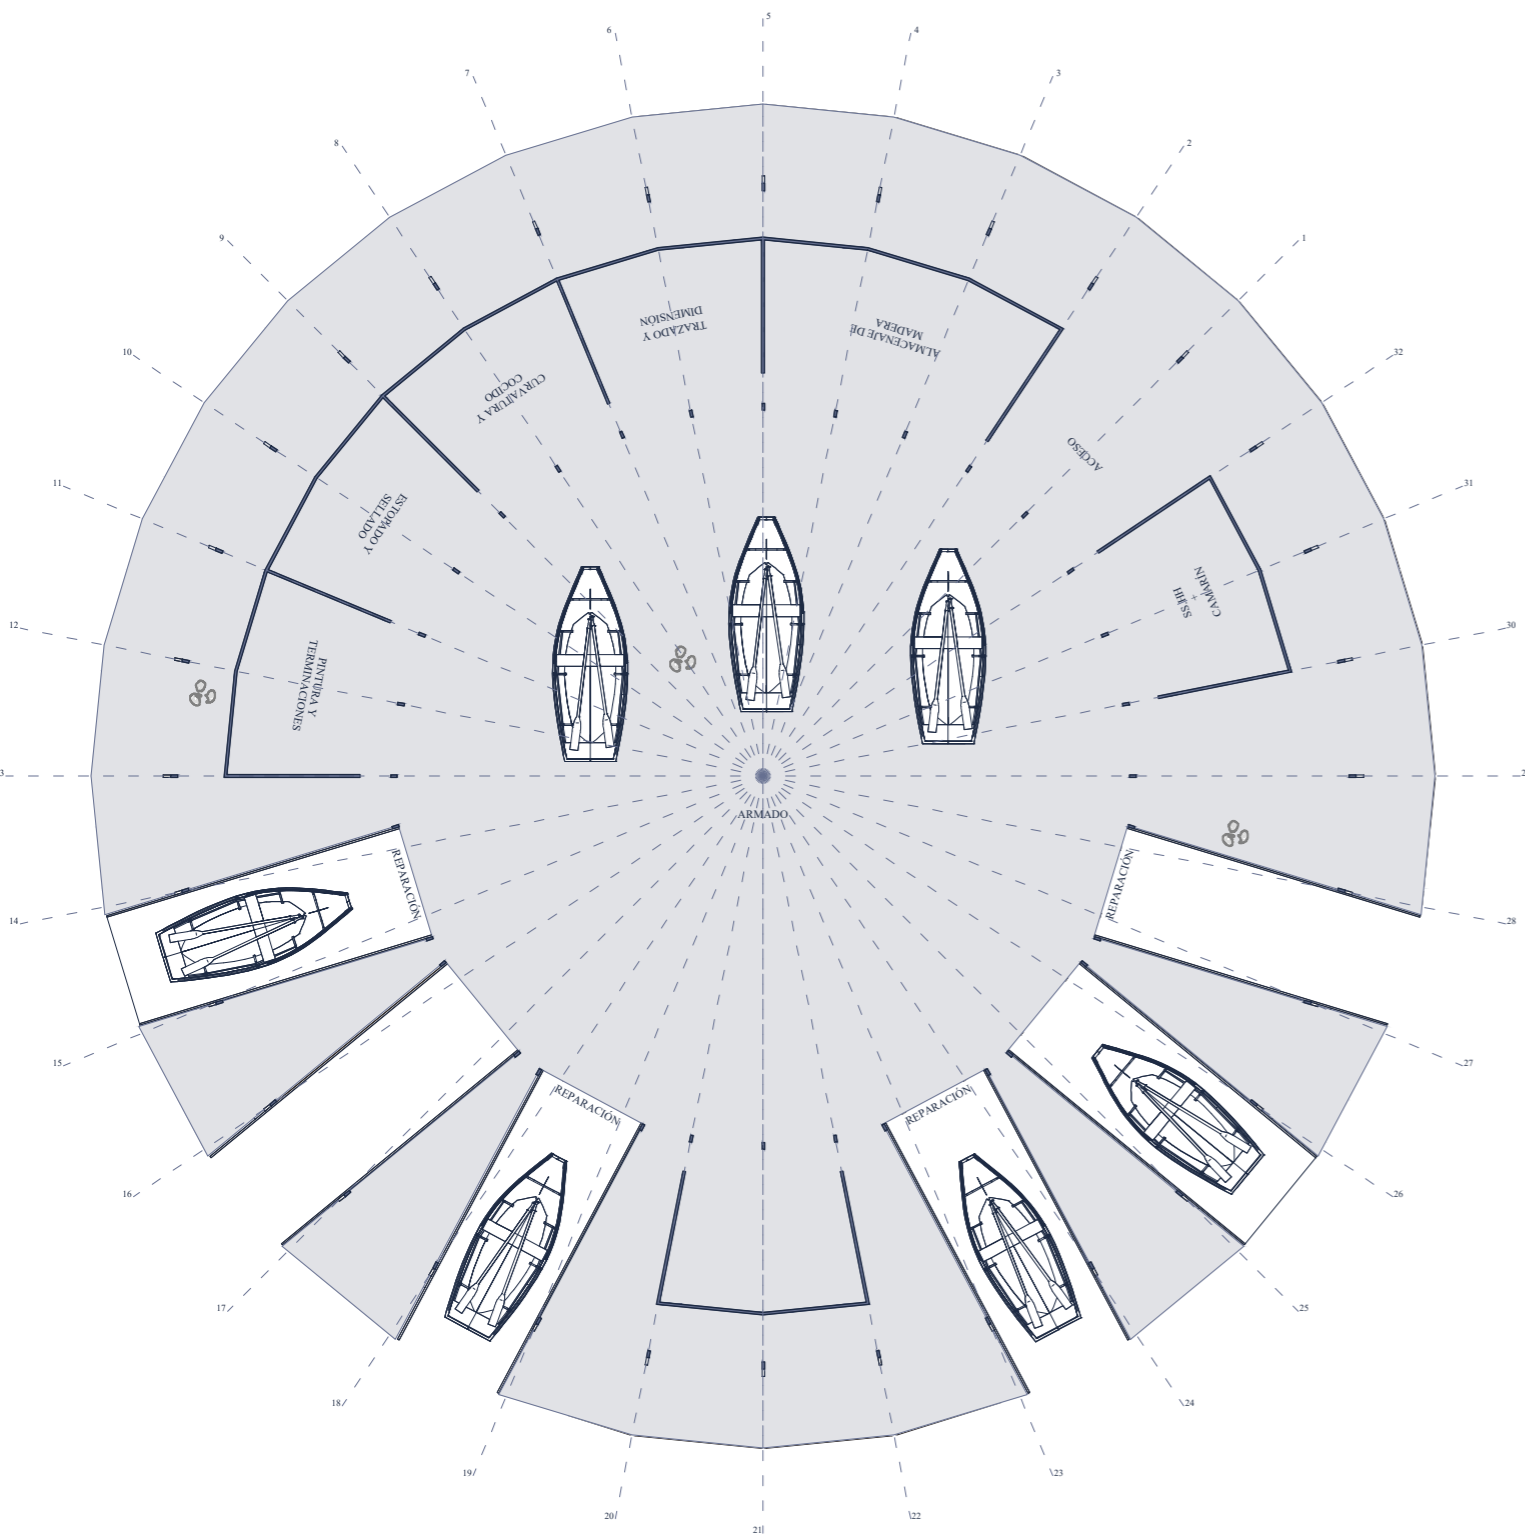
Planta esc 1:500. Fuente: Elaboración propia
